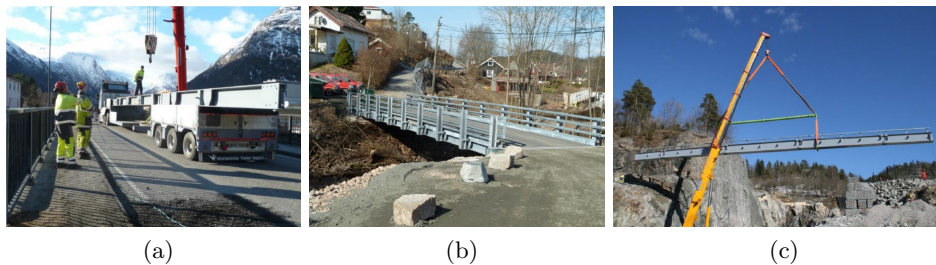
Alternativa de puente Quick Bridge (Mabey)
